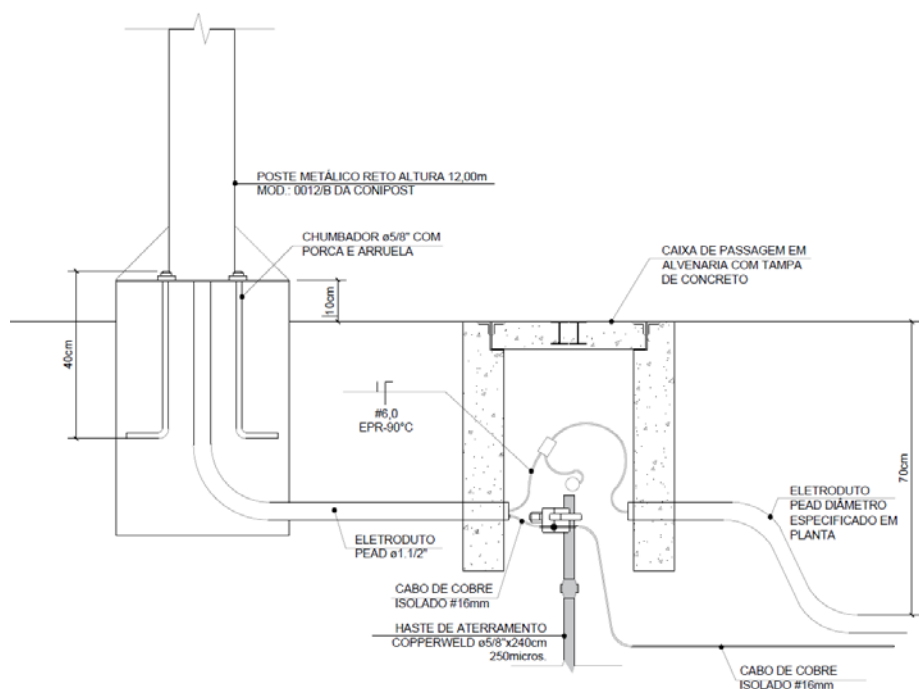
Fixação do poste flangeado entre barreiras e comunicação com a caixa de passagem
